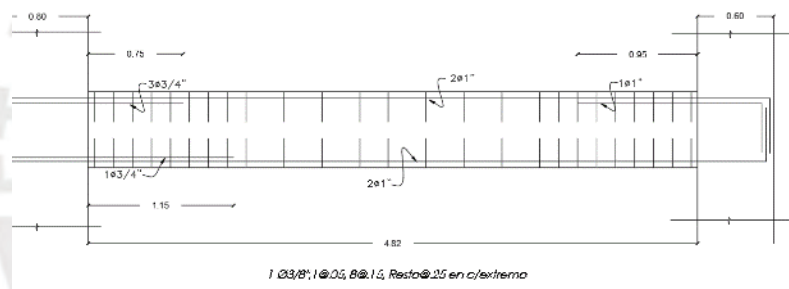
Detalle del refuerzo para la viga VT-07, tramo 4-5
